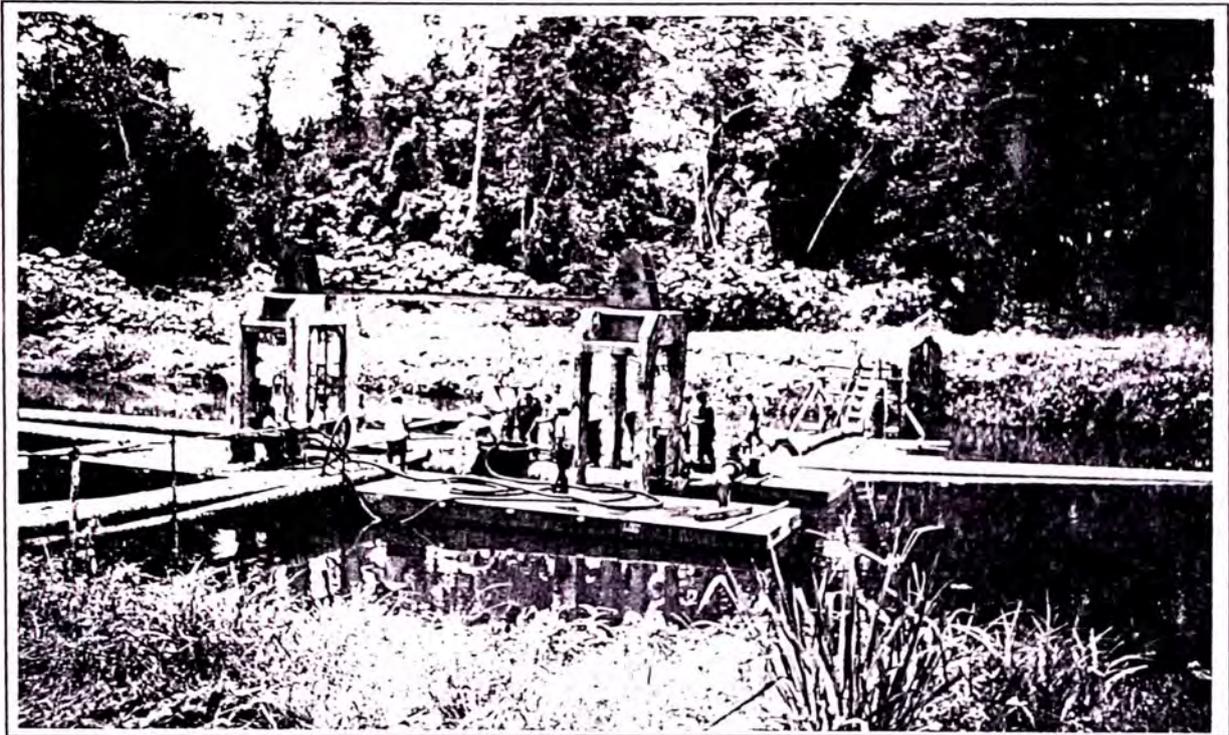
Preparación para corte de zona de reducción de 24" OD a 6"OD realizada para traslado del petróleo desde la margen izquierda a la margen derecha.
